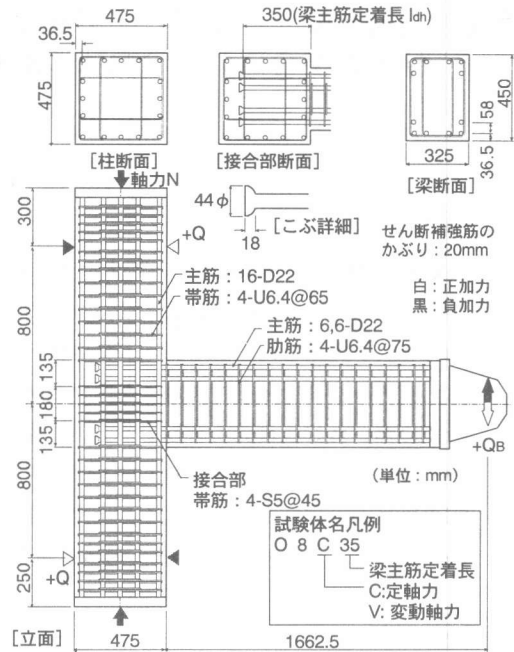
試験体の形状・配筋図 (試験体 08C35, 08V35)
